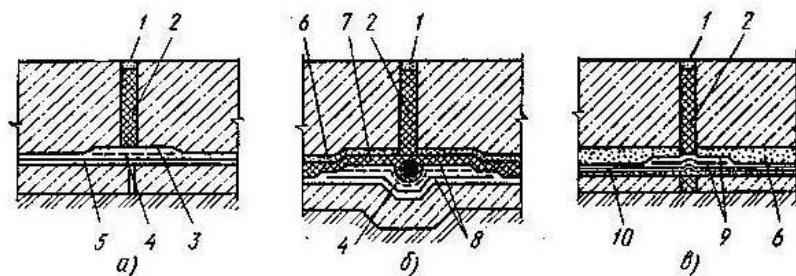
Гидроизоляция деформационных швов на фундаментных плитах или полуподвала (а—в):
